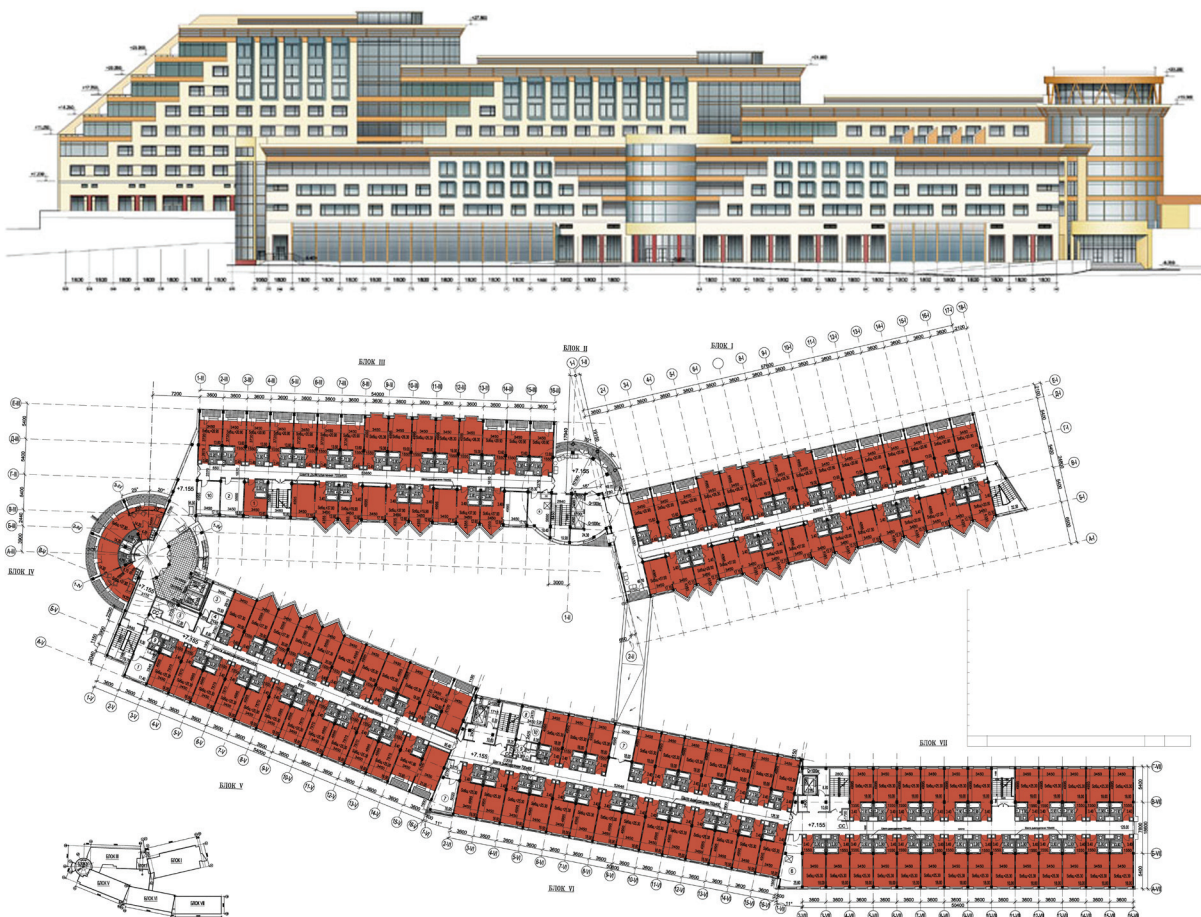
Кампус ДВФУ корпус № 9, фасад и план типового жилого этажа
